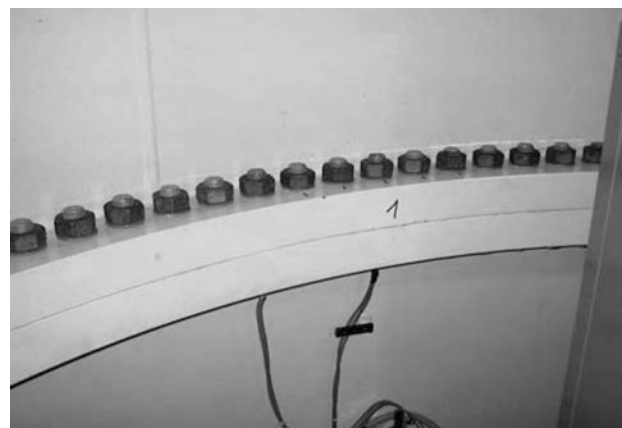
Detalle de la conexión entre bridas en torre metálica. Imagen tomada de [5]
